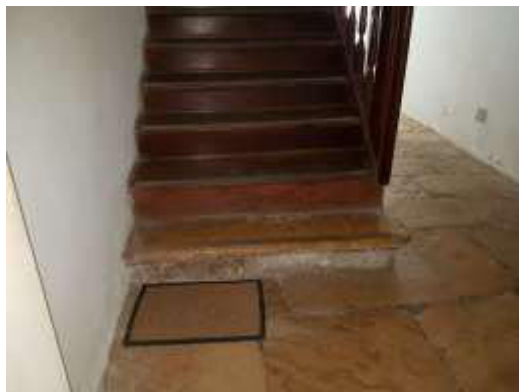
Rua da Palma, n.º 336. Degrau de chegada em pedra de lioz da escada de acesso ao primeiro pavimento.
